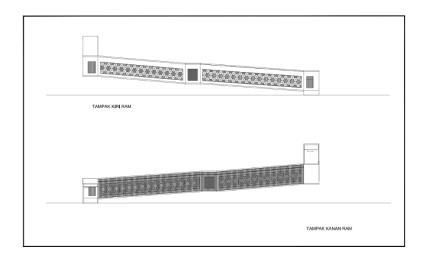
Denah Rencana ram Sumber: dokumen pribadi
